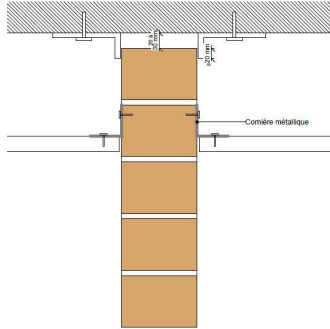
liaison avec un sous plancher déformable ou non avec faux plafond
